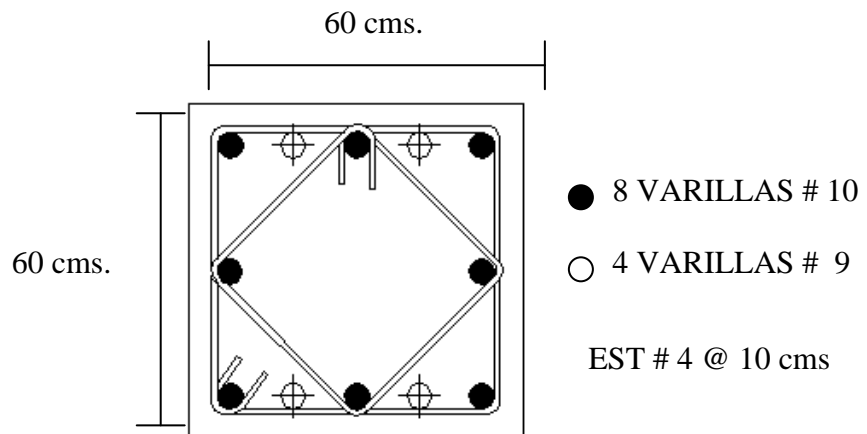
Sección transversal de columna de primer nivel. (Edificios de 5 niveles).
